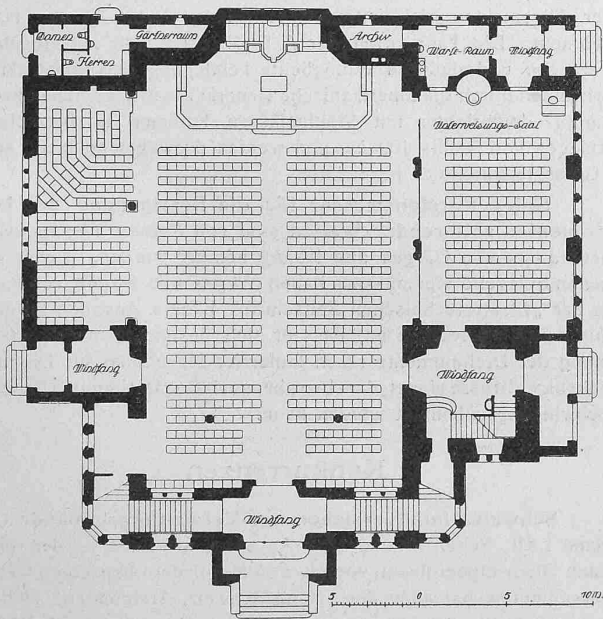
und 5. Grundrisse der evangelischen Kirche in Romanshorn. — Masstab 1:400.
